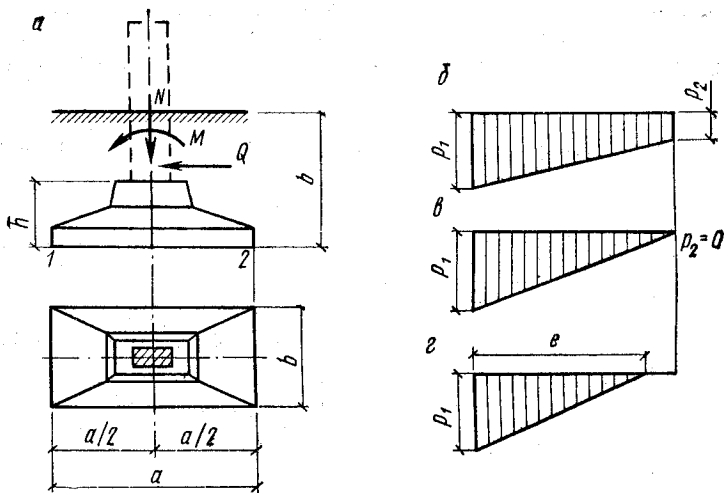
К расчету внецентренно нагруженного фундамента
